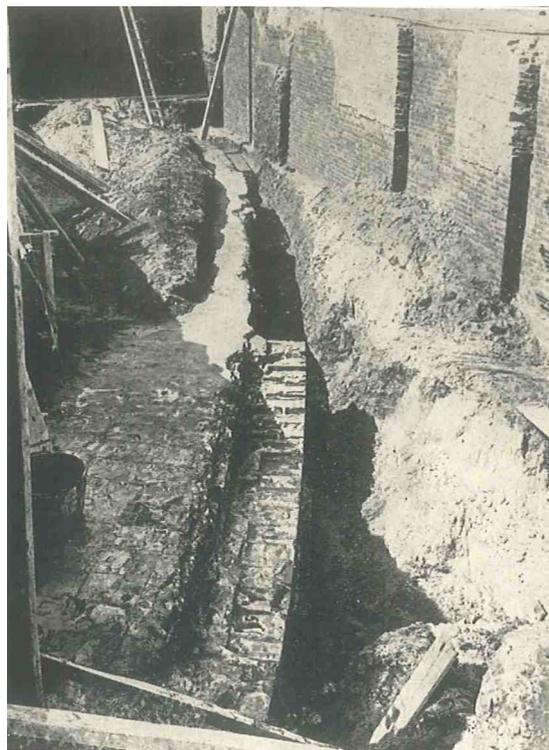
Pavia. Resti delle fondazioni del teatro pavese, visti da Nord (Nocca 1935, tav. LXVI, fig. 2)
